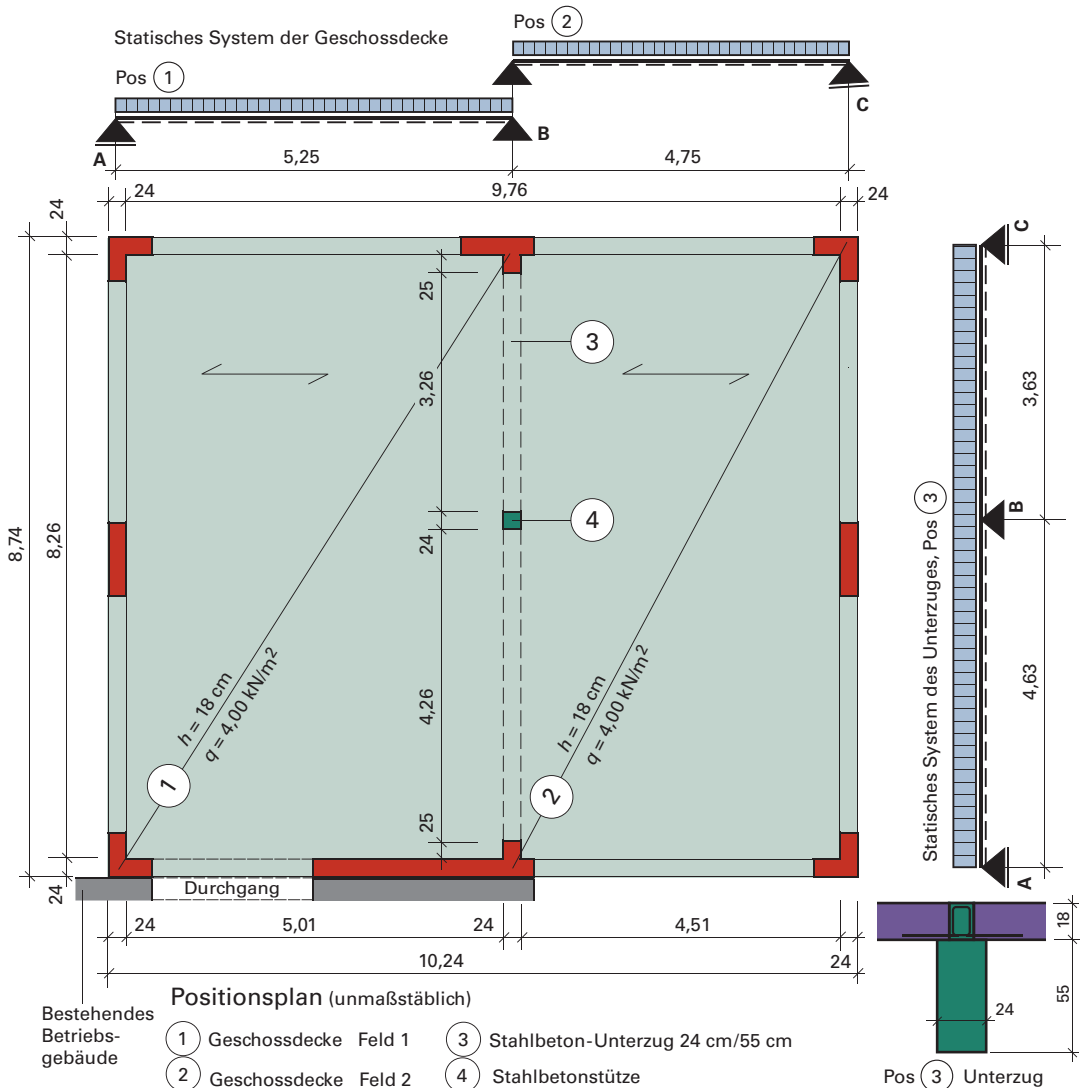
Positionsplan für den Anbau Betriebsgebäude
